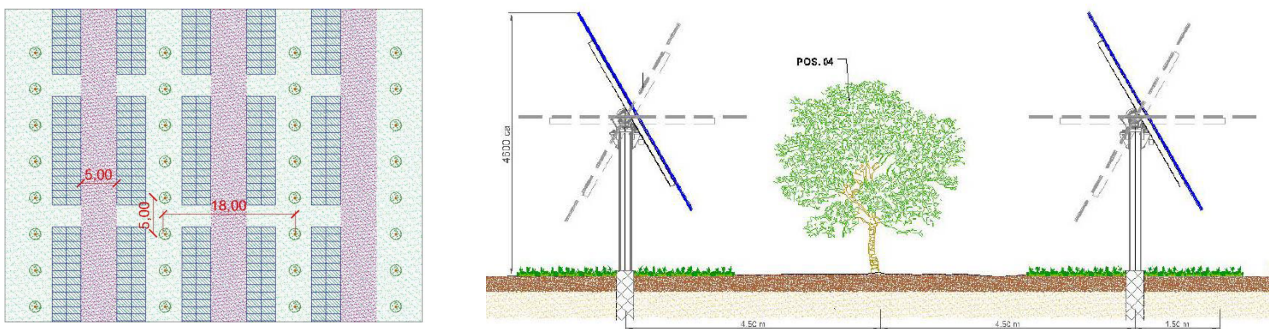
Schema del sesto d'impianto del sulleteo e dell'uliveto nelle fasce interfilari e sezione dell'uliveto interfilare
